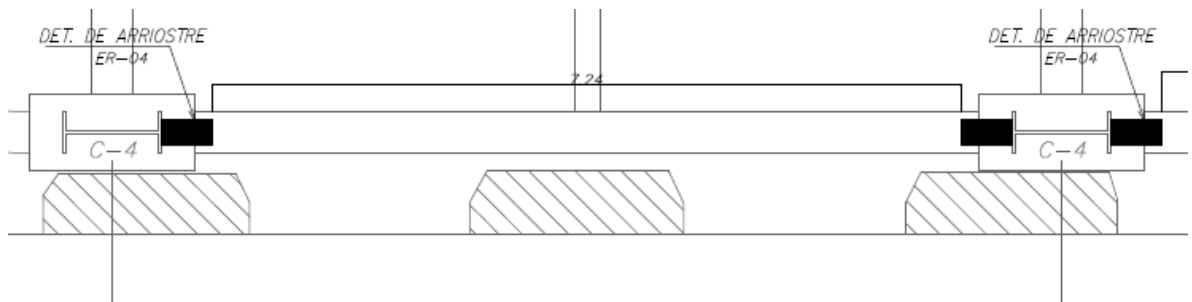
Detalle en los planos de aligerado para indicar la ubicación del pórtico
